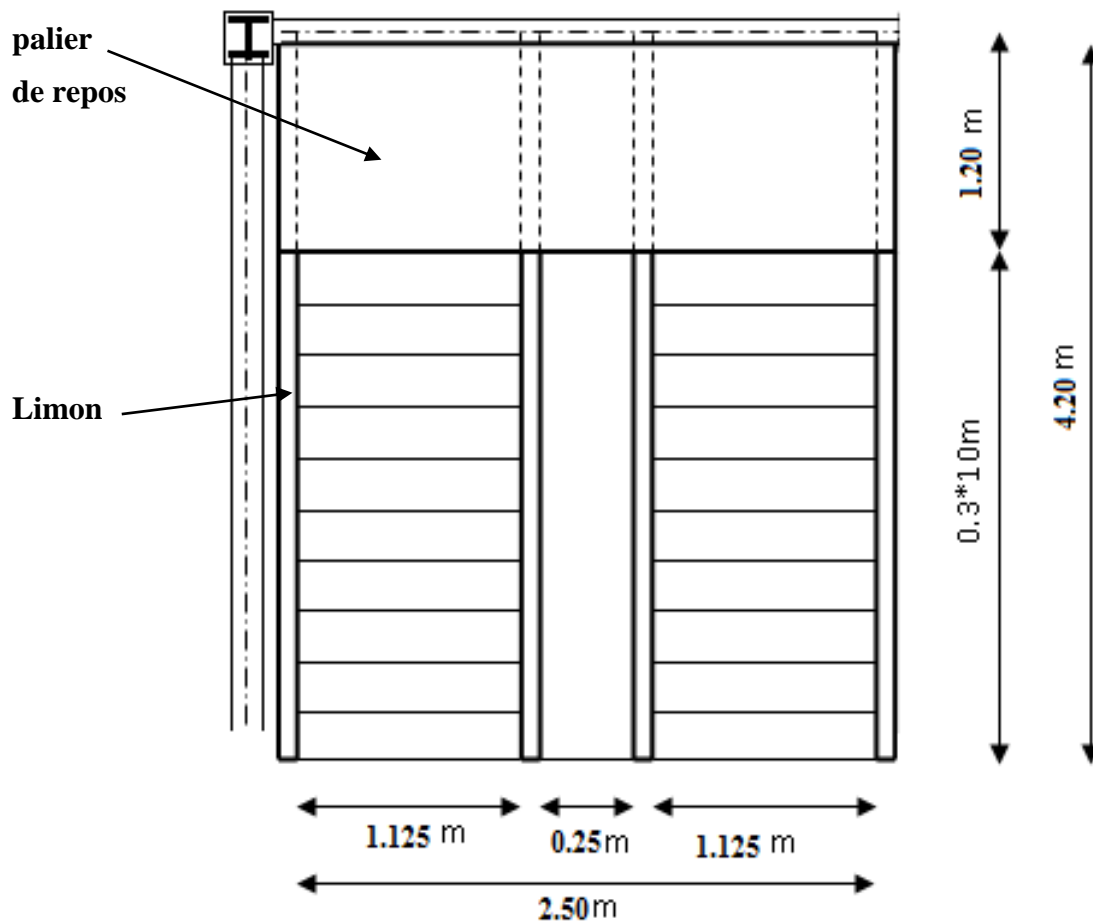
2: Vue en plan d'escaliers en acier et disposition des éléments
